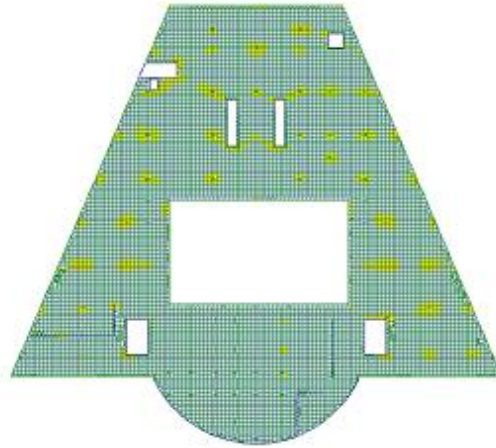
Площадь полной арматуры на 1 мм по оси Y у верхней грани
